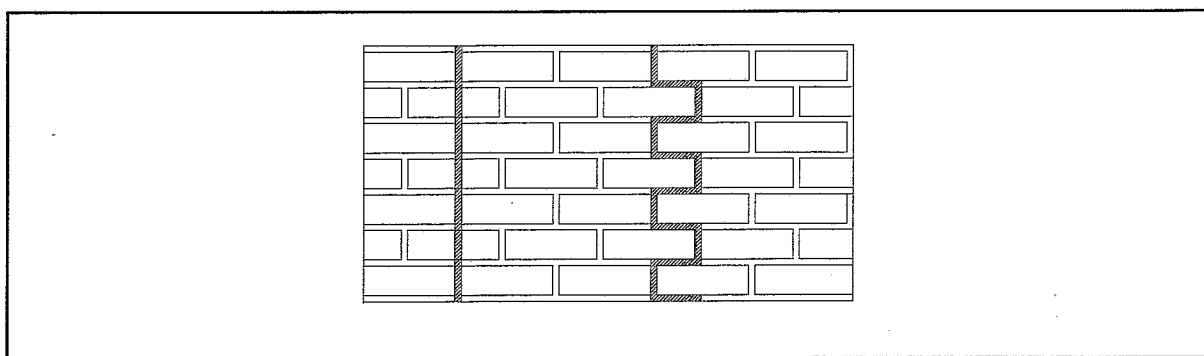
Pormenor do seguimento da junta vertical flexível de dilatação/contracção em alvenaria de tijolo de face à vista
